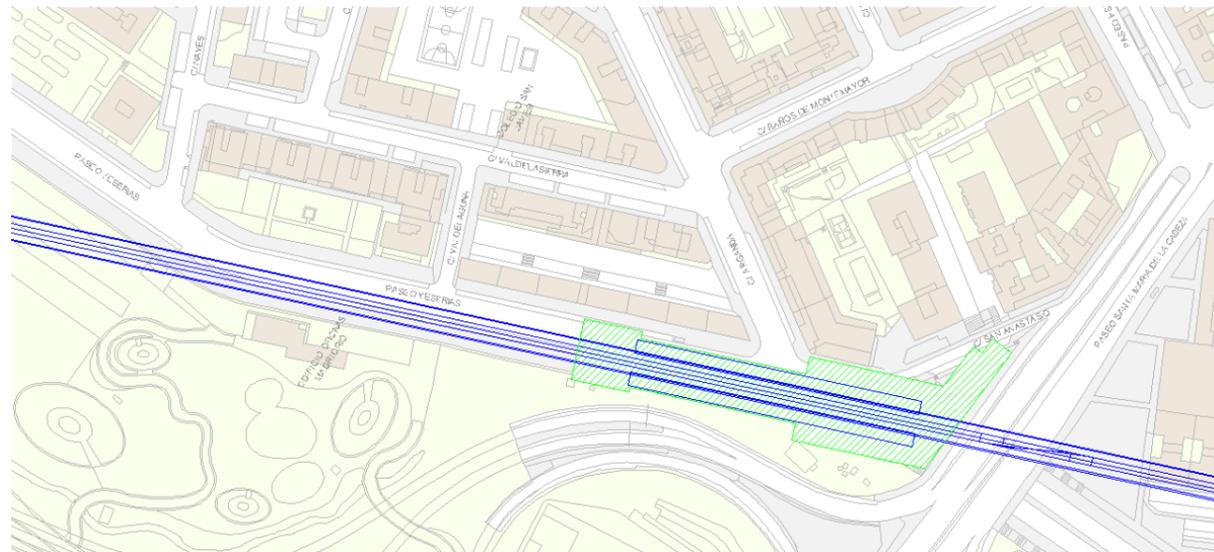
Planta de emplazamiento de la estación Madrid Río L11, Alternativa 1.
